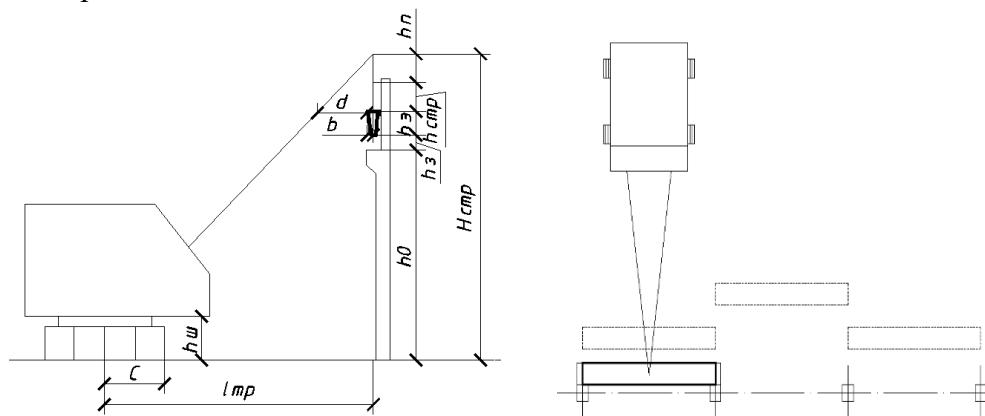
Схема для определения технических параметров крана для монтажа подкрановой балки
